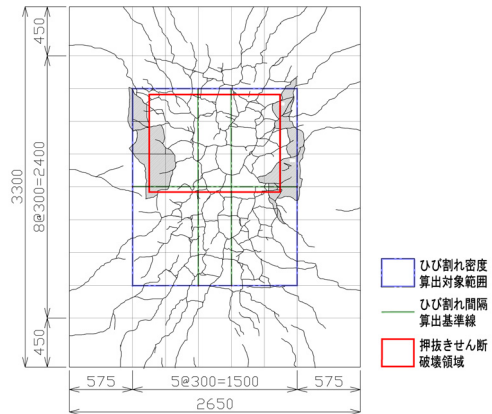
丸鋼鉄筋供試体ひび割れ状況（実験終了時）
